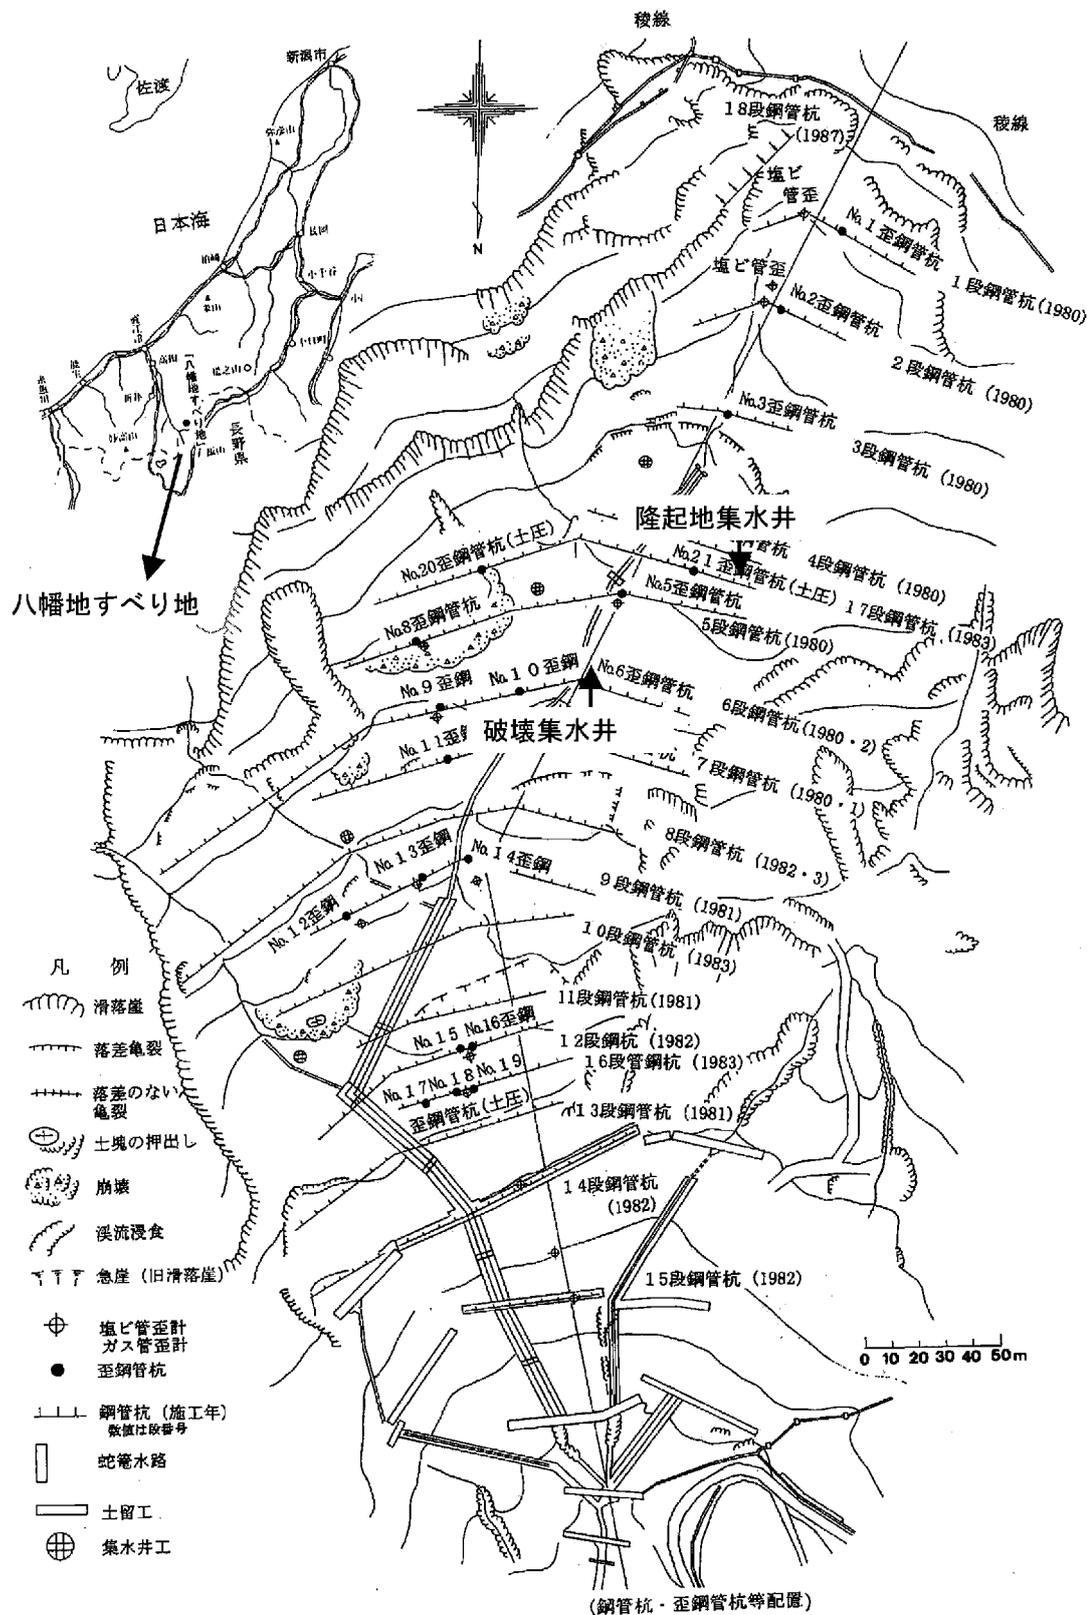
蛇香沢上部斜面平面図 八幡地すべり地(妙高市)
